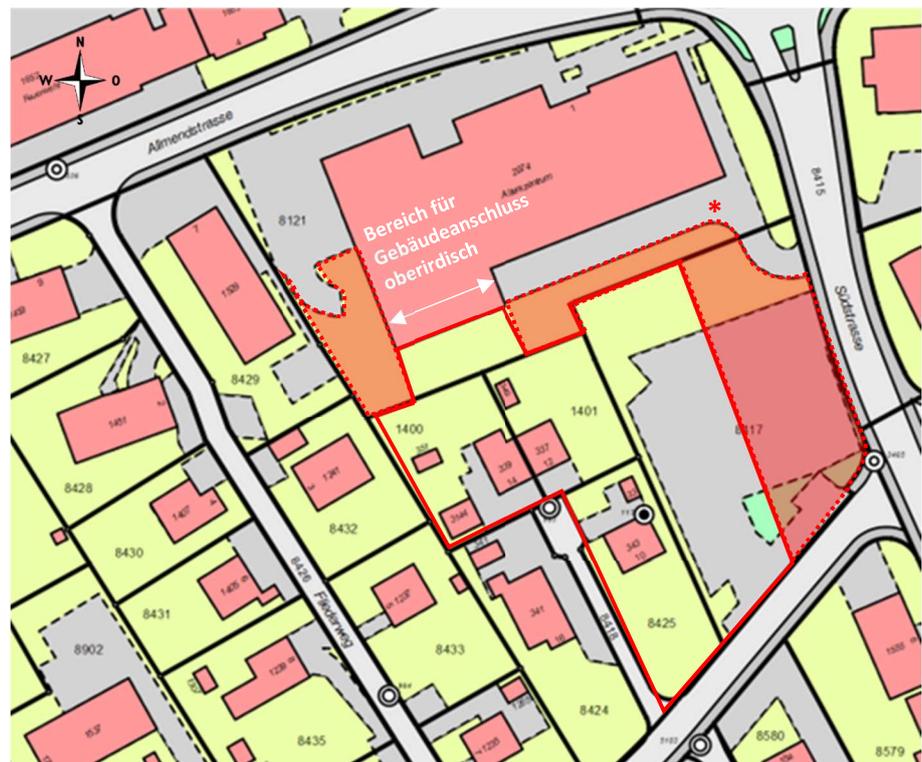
Ortsplan mit Bestand und Bauperimeter inkl. Gebäudeanschluss
